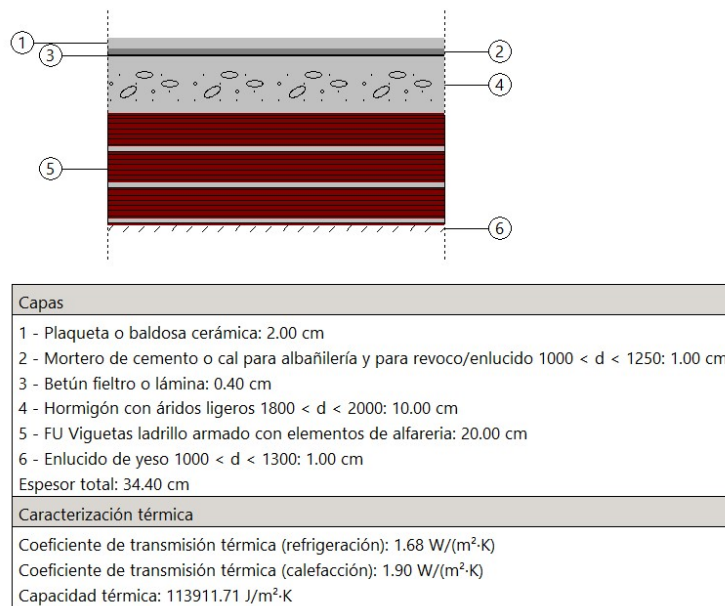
Detalle de cubierta (Elaboración propia, 2024)
